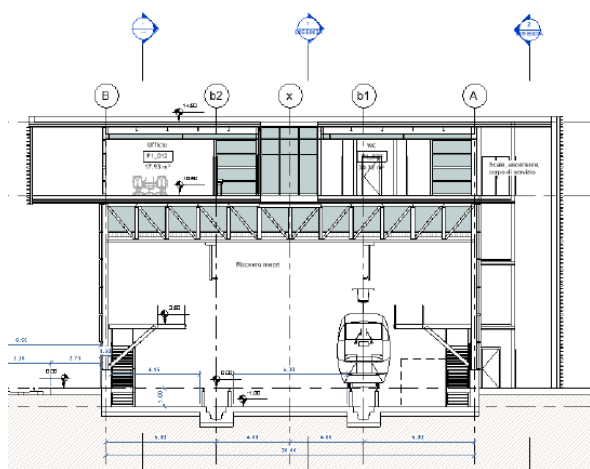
sezione trasversale del Locale Rimessa e rappresentazione dell'interno dell'area di manutenzione. Fonte Lista di Controllo
